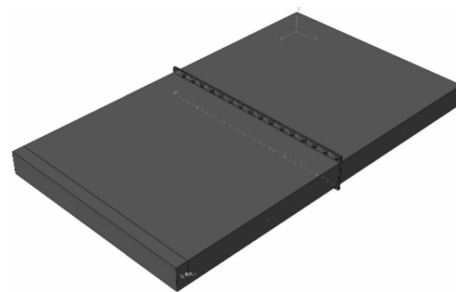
预制法兰板-螺栓连接钢板混凝土剪力墙模型
